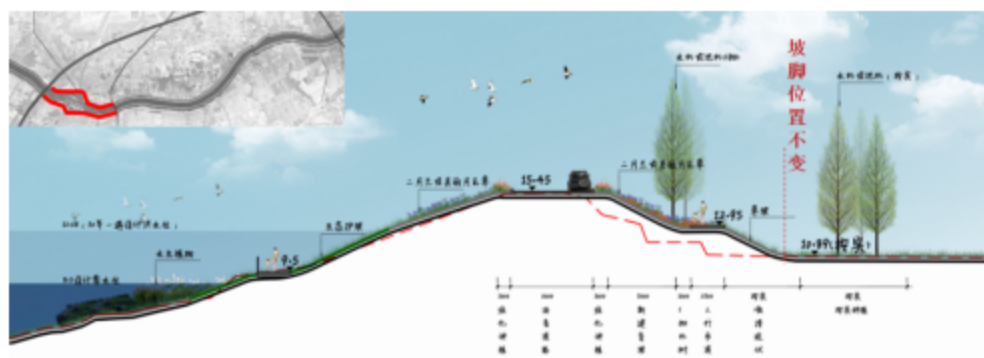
特色过渡段背水坡新建钱台、步道断面图
